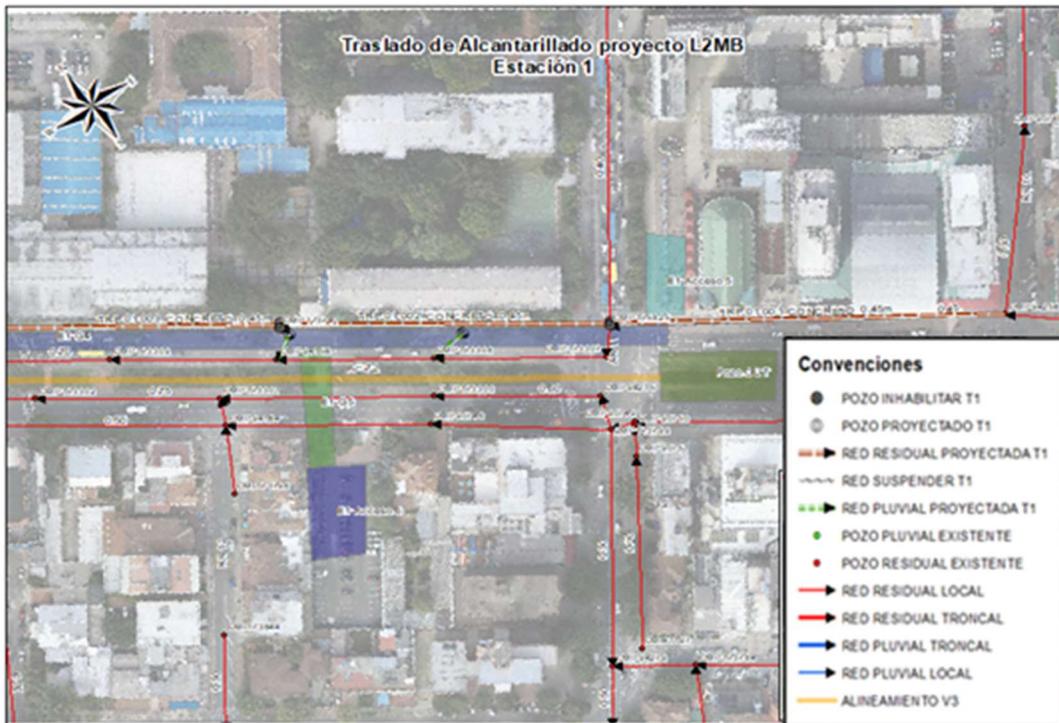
Traslado redes de alcantarillado Estación 1 Calle 72 con Carrera 13
